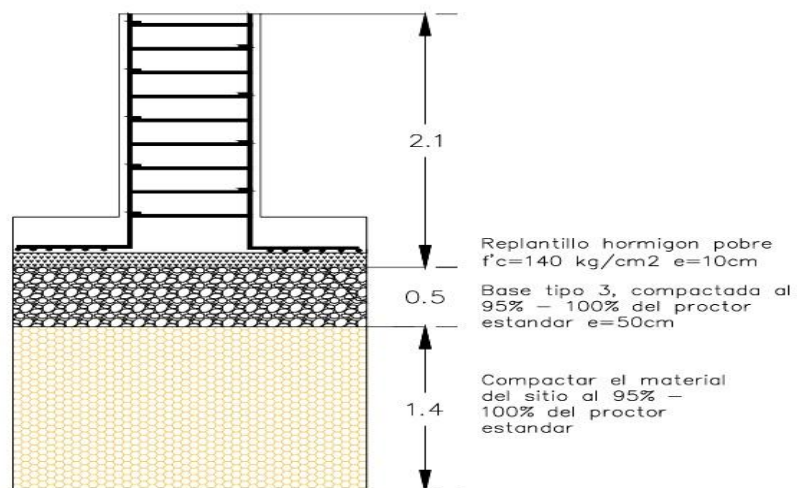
Esquema de cimentación sugerida para la construcción de la edificación
